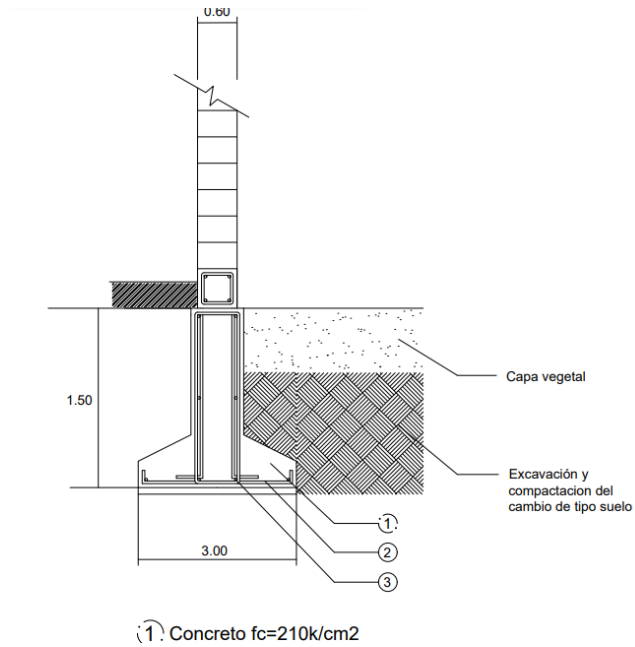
Detalle de zapata de cimentación, Restaurante.
